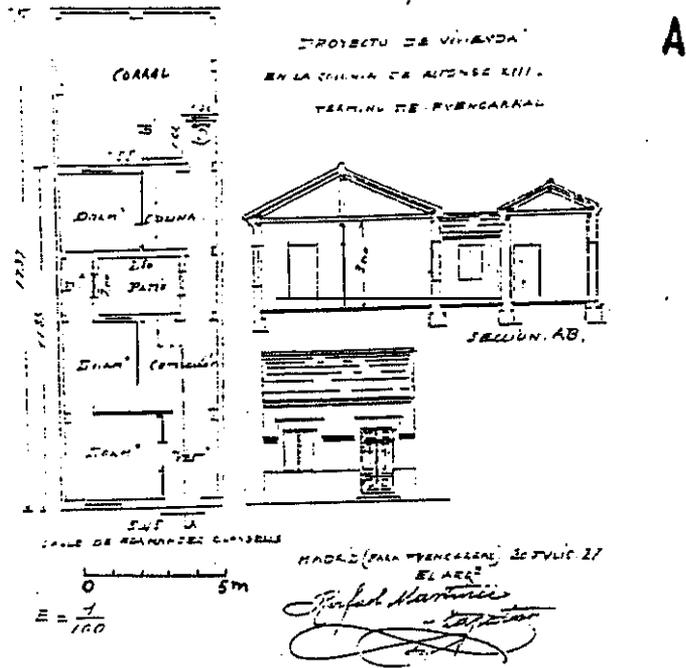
Adaptación de las viviendas al trazado parcelario.
